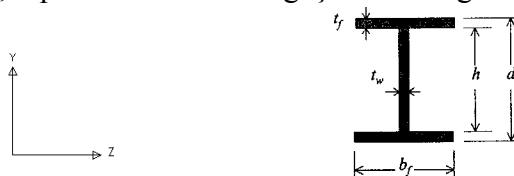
Seções dos perfis metálicos das vigas e pilares do pórtico.
